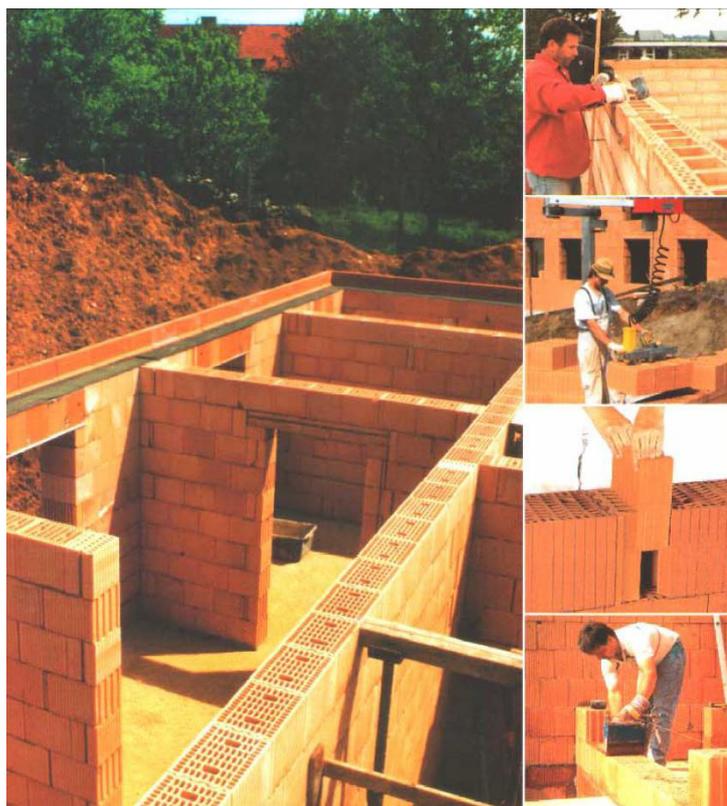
Exemplo de edifício em alvenaria cerâmica estrutural construída na Alemanha (Lourengo, 2007)
